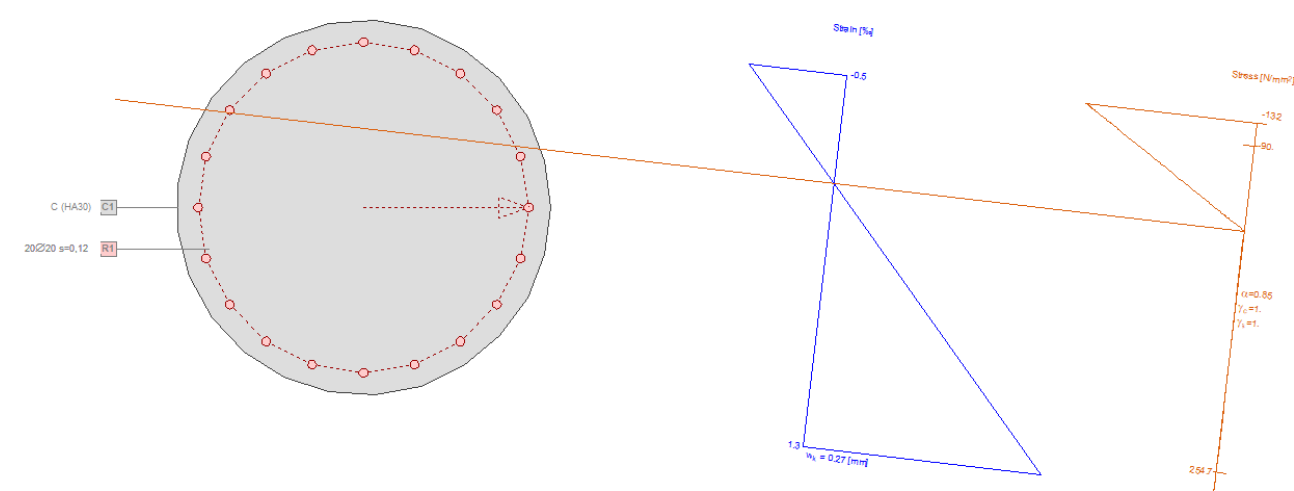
Càlcul de fissuració màxima dels pilons de la piles 1, 2, 8 i 9
